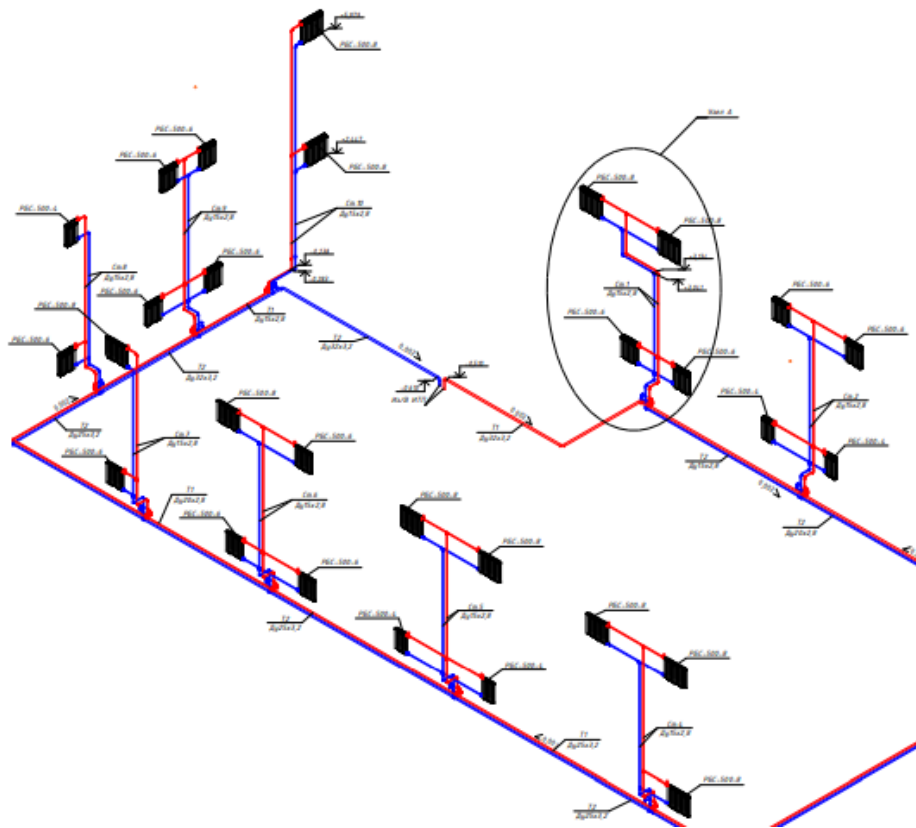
Фрагмент схемы системы отопления учебно – оздоровительного комплекса
